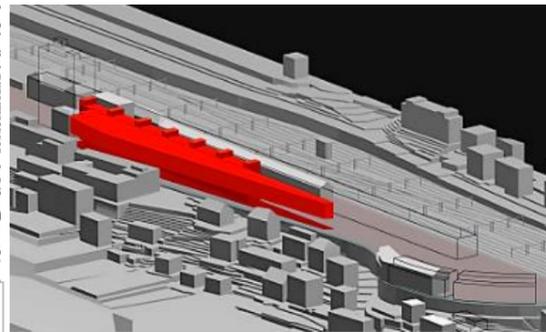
Plan de masse de l'OFS. Source : www.bauart.ch. Traitement: Auteurs.
